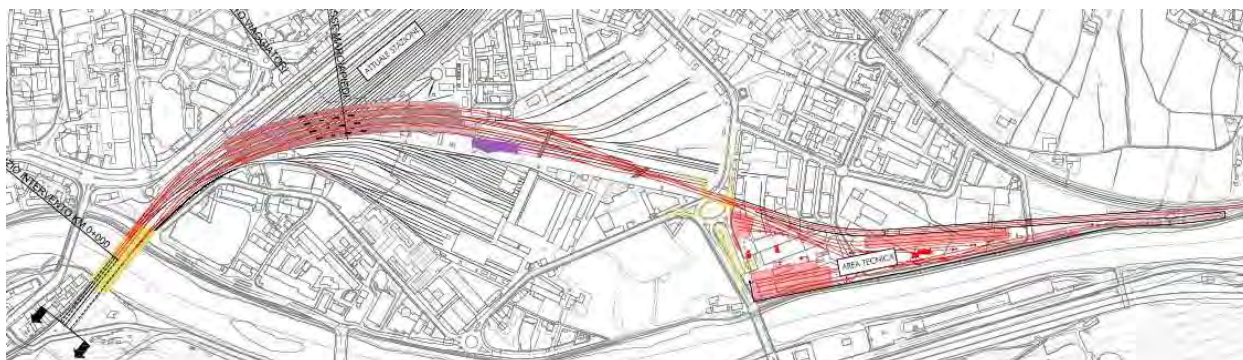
Planimetria con le aree d'intervento progettuale (in rosso)
